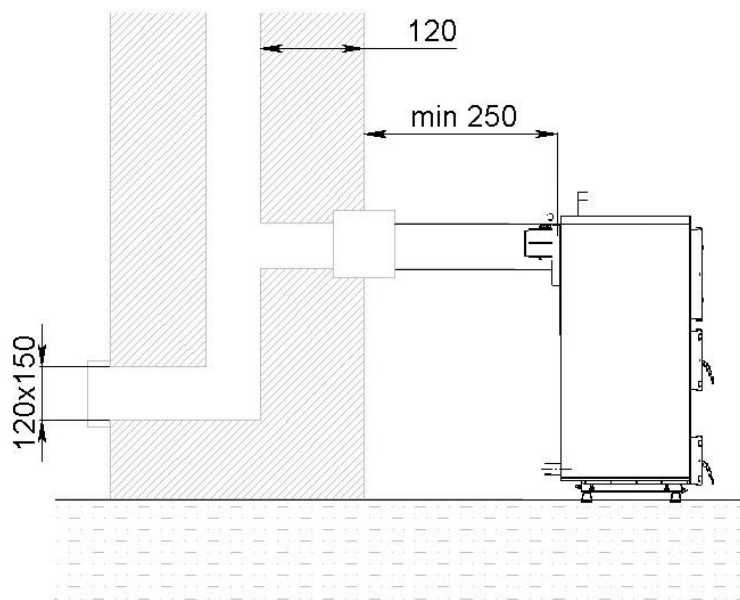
а. Устройство сажесборника и ревизионного окна при расположении дымохода в шахте (вид сбоку)
